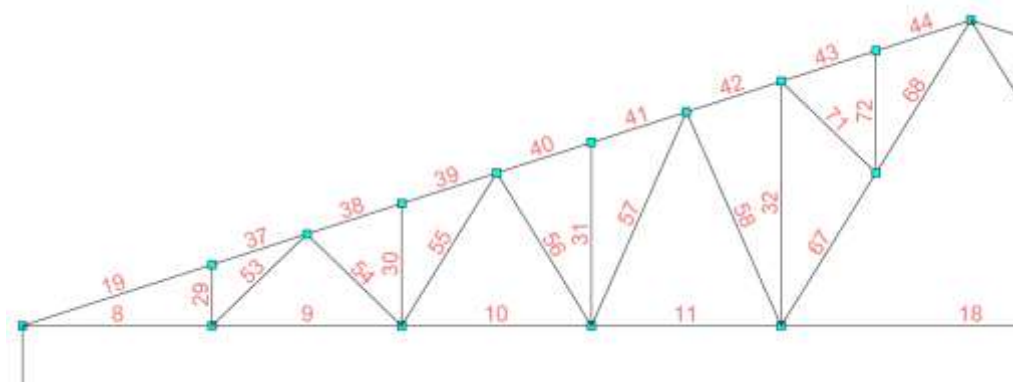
Фрагмент розрахункової схеми каркасу будівлі з нумеруванням елементів (для ферми в осях А-Б)
